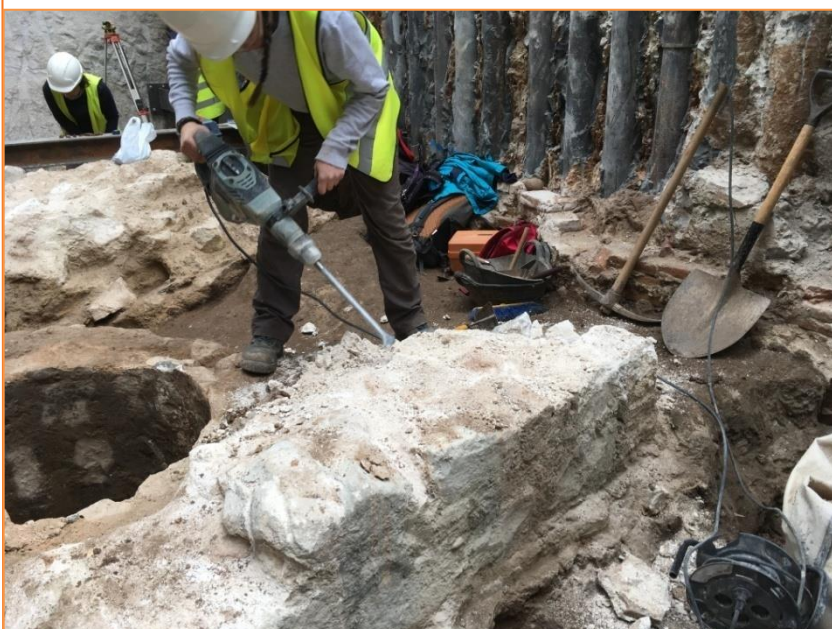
Vista dels treballs de desmuntatge del mur UE 305.
